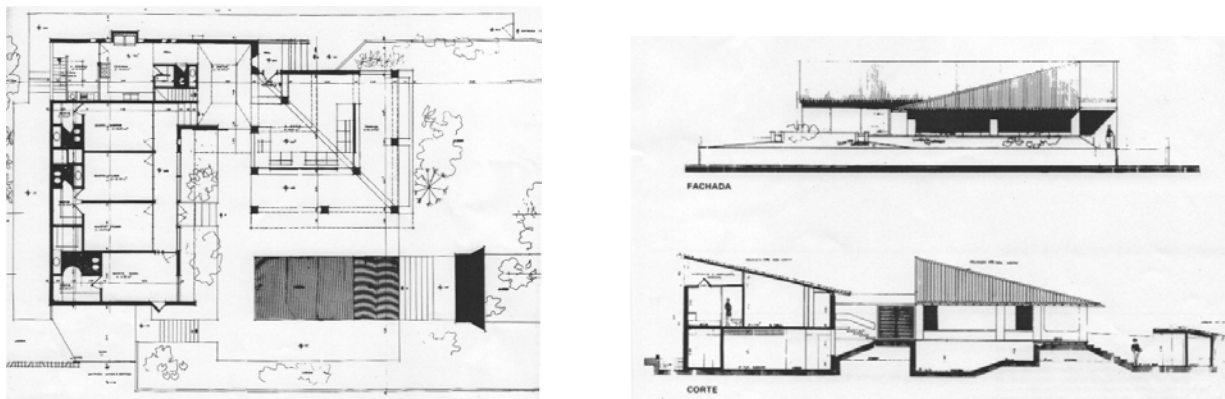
Planta, Fachada e Corte da Residência de Veraneio Clovis Rolim (1974)
